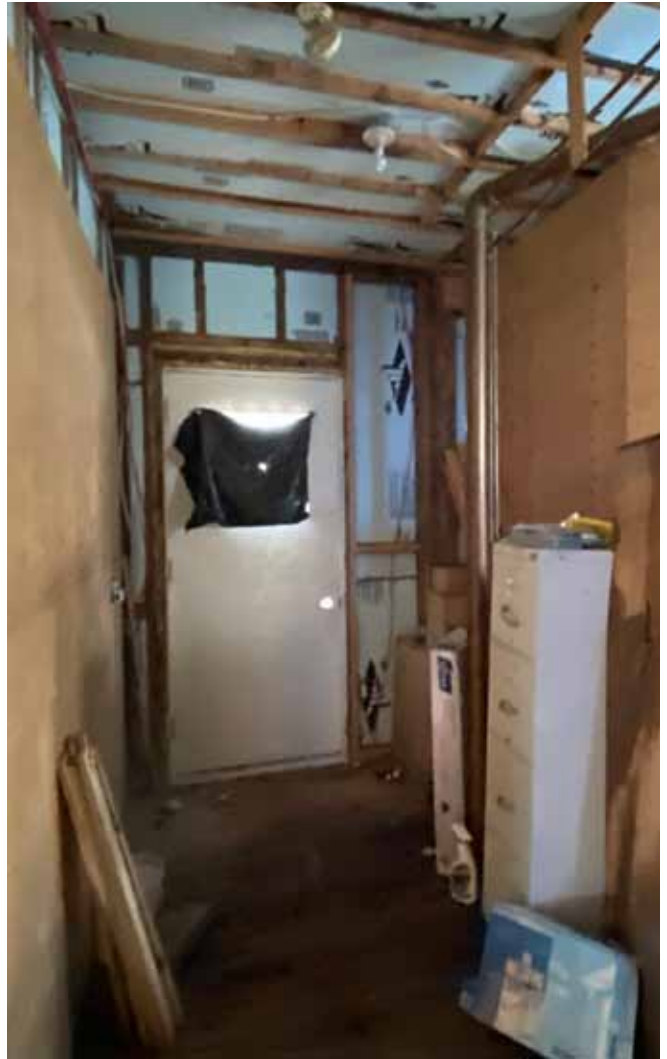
La porte donnant sur la galerie sur la façade latérale est en bois peint en blanc avec un vitrage carré en partie supérieure.
